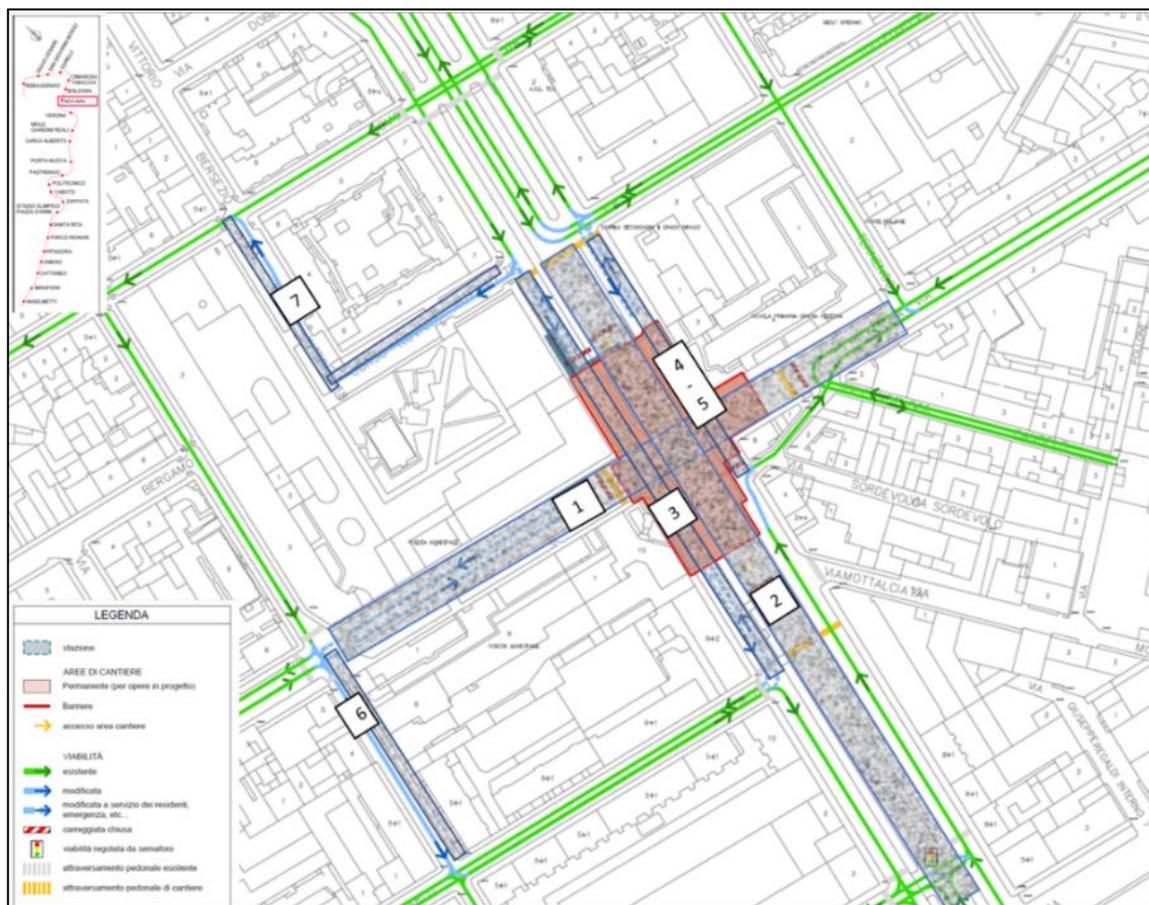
Planimetria di progetto degli interventi di Fase 1.
